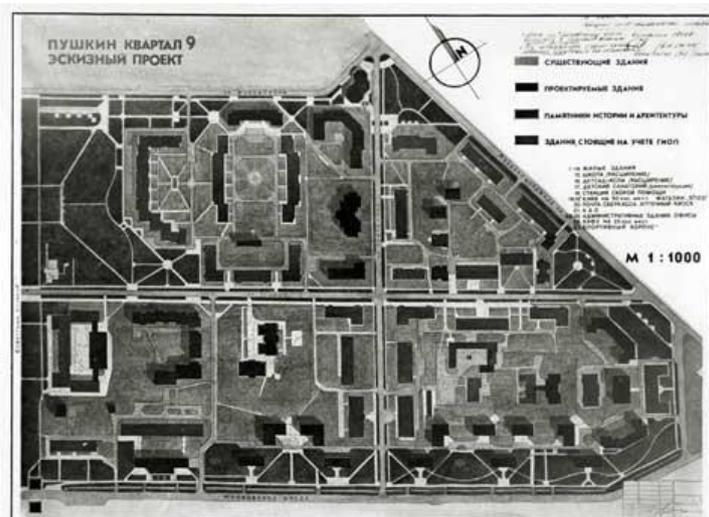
Комплексная реконструкция квартала в городе Пушкин
